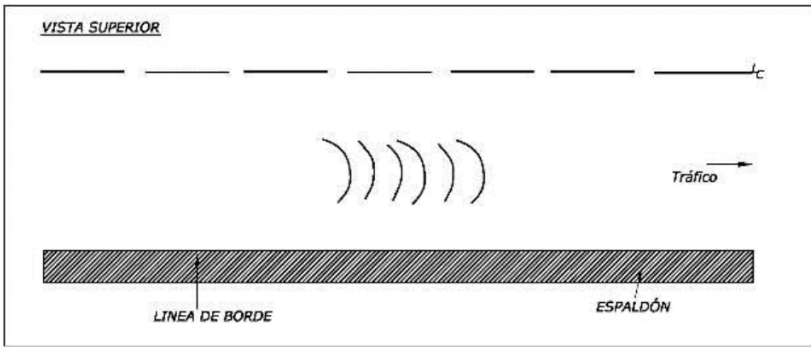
Esquema Grietas en Arco – Pavimento Flexible
